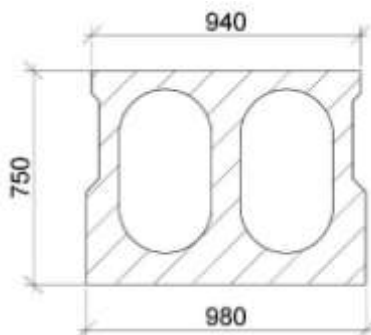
Поперечний переріз залізобетонної балки прогонової будови
